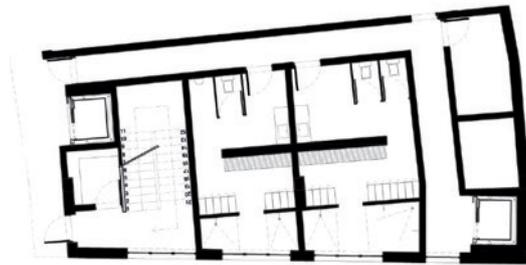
Planta Piso 0 | Salas de Lazer | Bloco B
